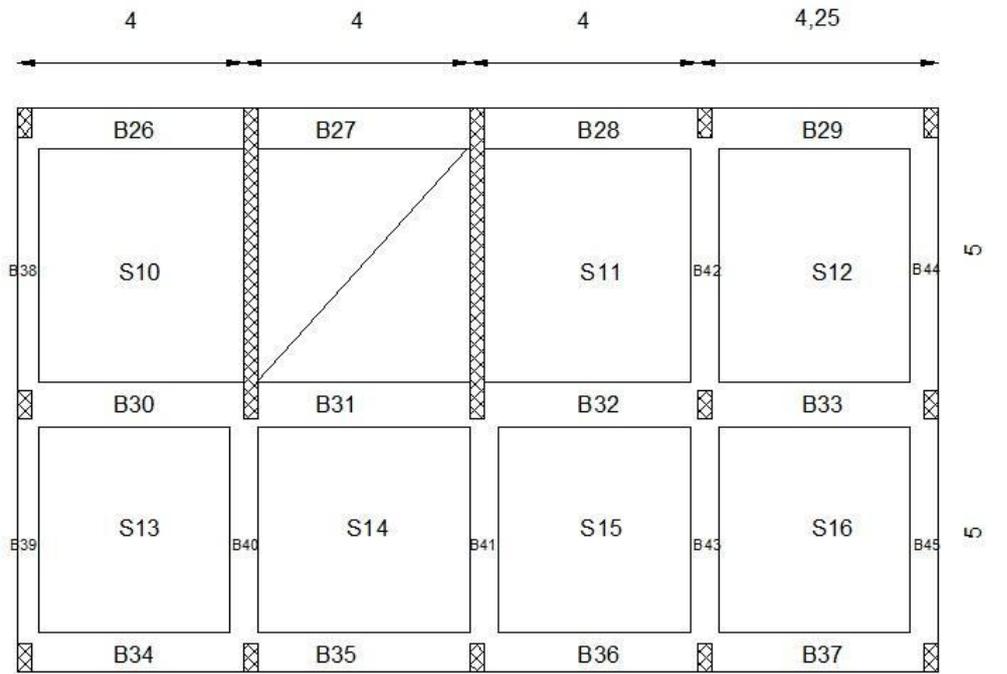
مسقط أعمدة و جدران الطابق الأرضي
